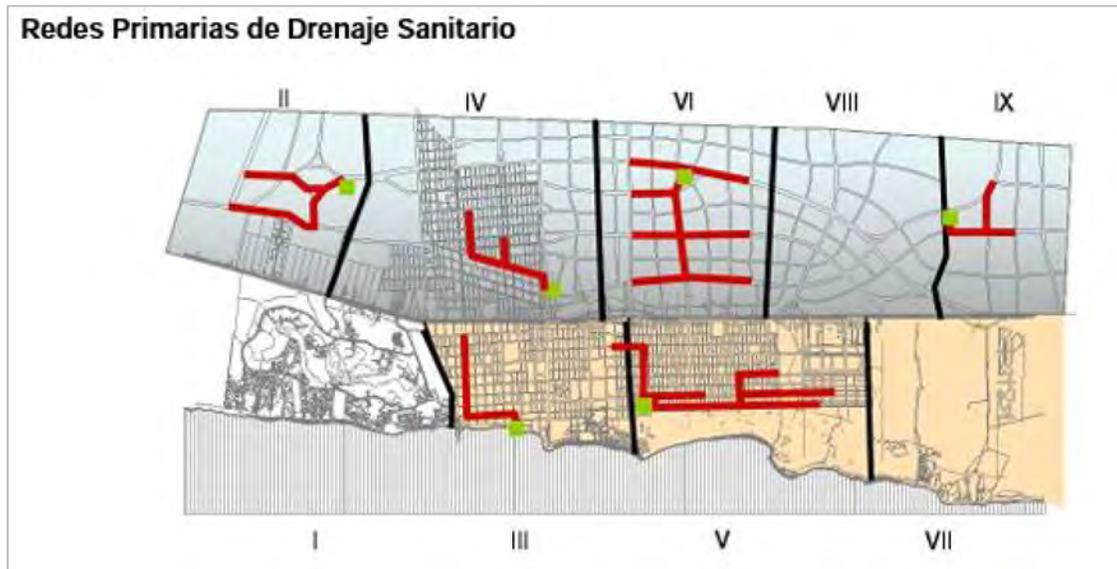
Se muestran las redes de drenaje sanitario en Playa del Carmen.
